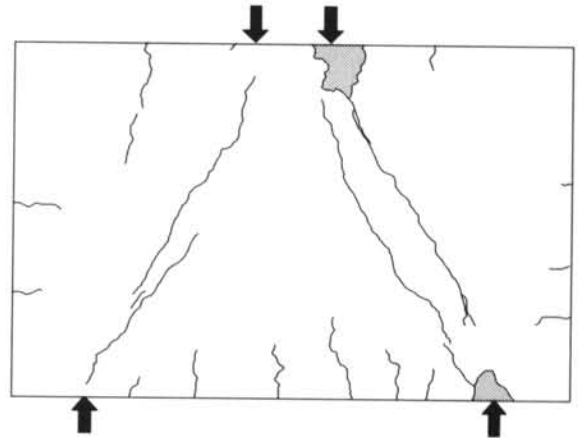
試験体 LR0 のひび割れ発生状況 (実験)
